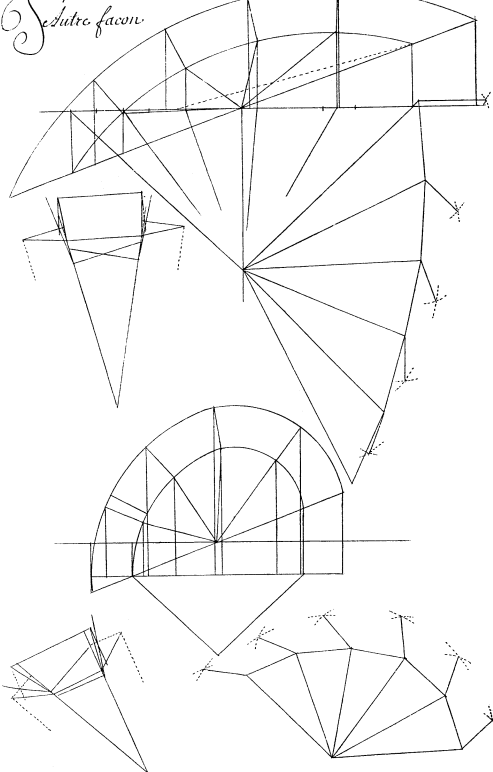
Tavola 66, Trompe Rampante par haut et par bas, La Mesme d'une Autre facon, ff. 65v.-66r.
